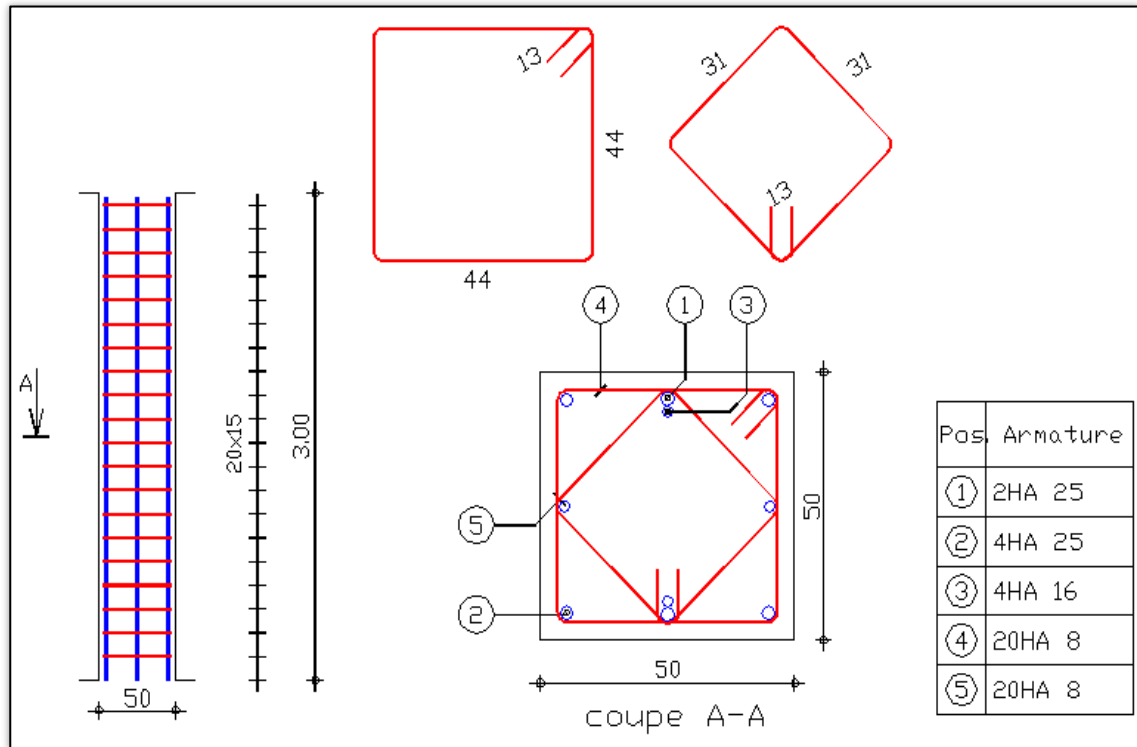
schéma de Ferrailage du poteau selon l'Euro code 2
